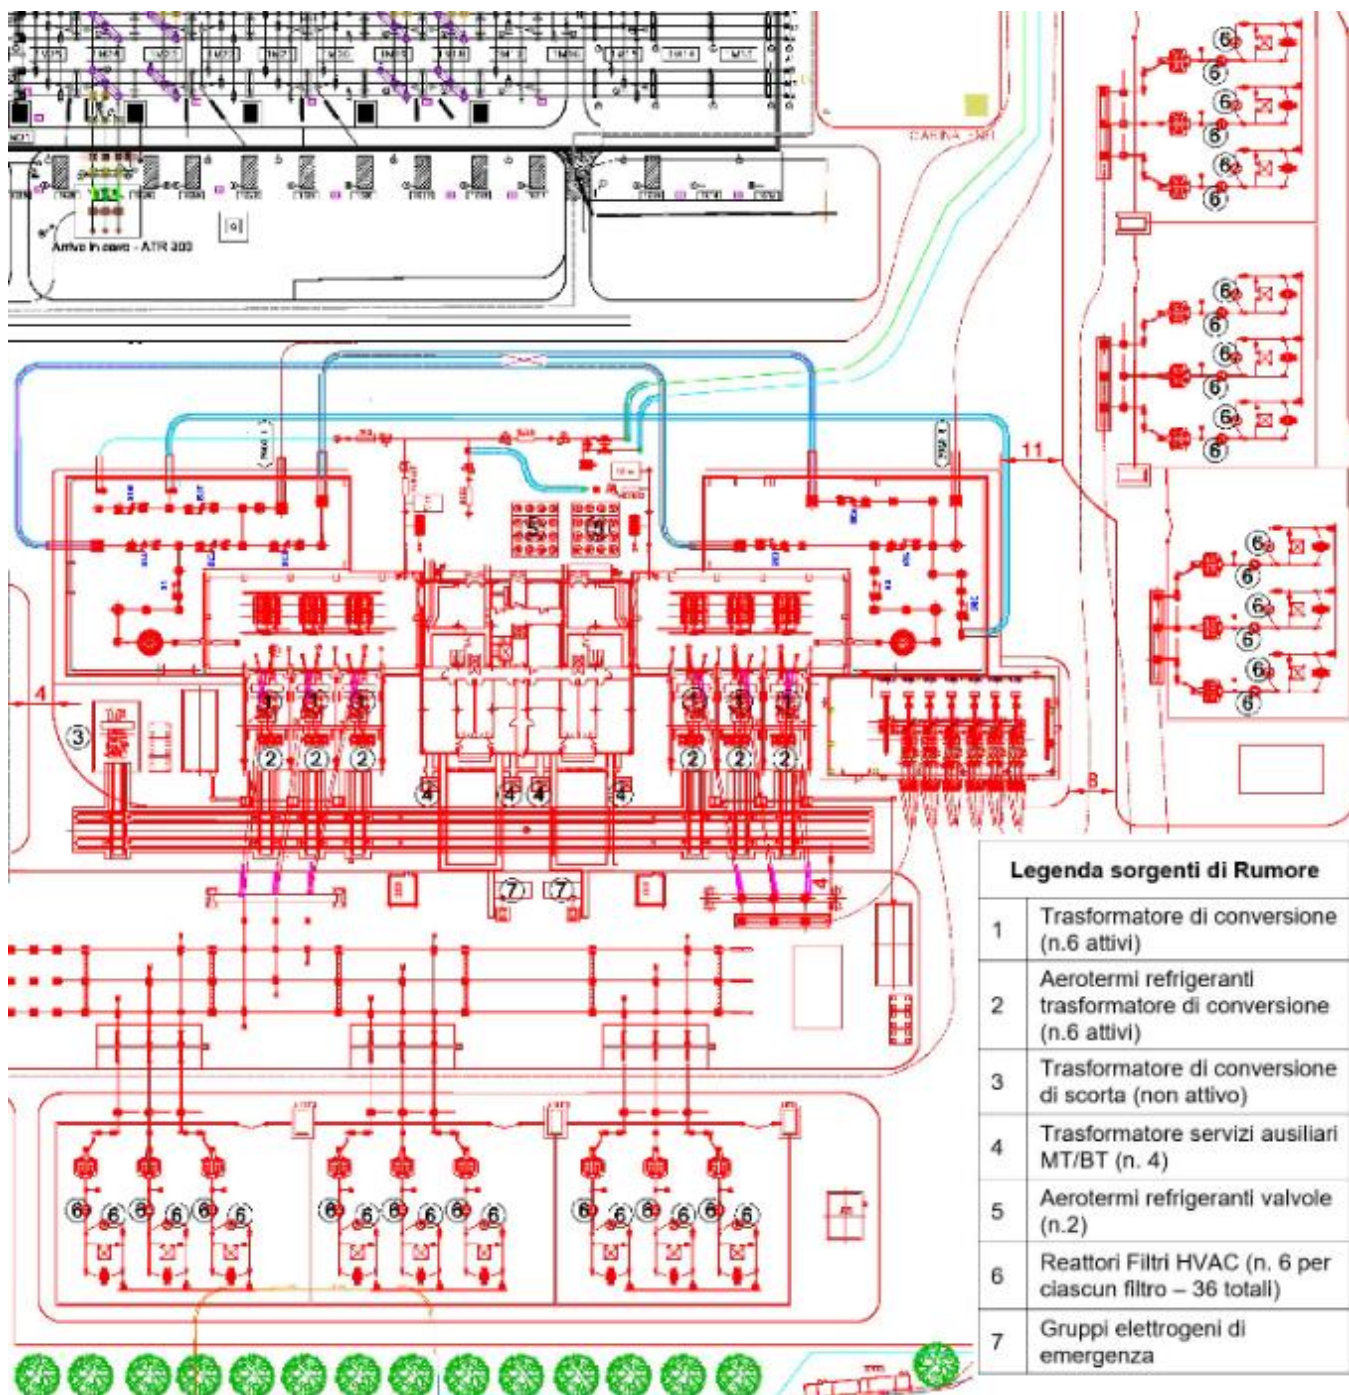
Layout nuovi impianti stazione elettrica di Suvereto
